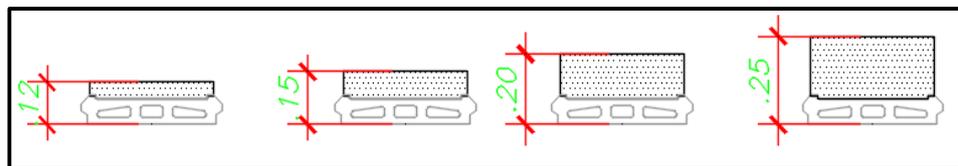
Detalle de bandejas de concreto más bloques de poliestireno.
